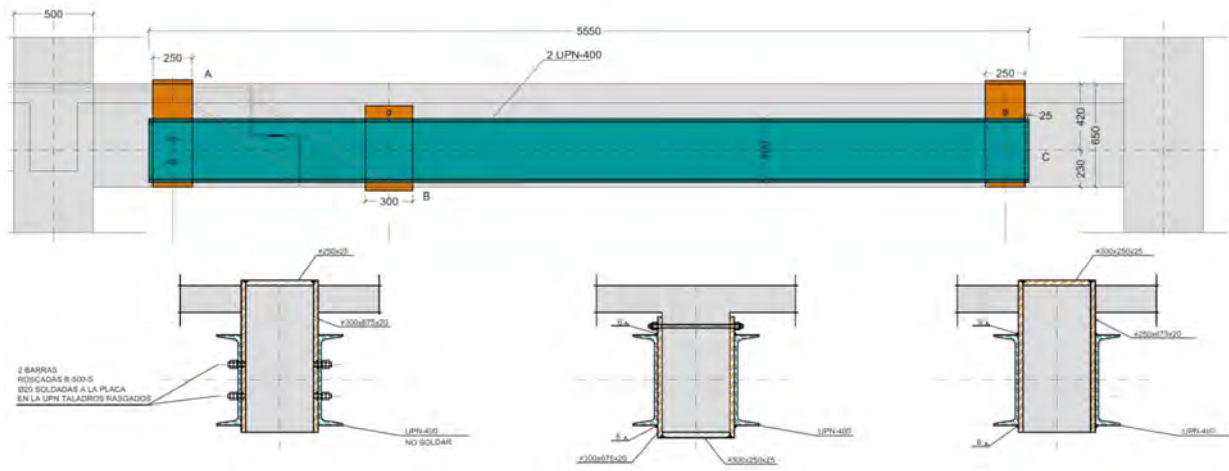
Refuerzo metálico tipo de una viga longitudinal en tramo de junta.
